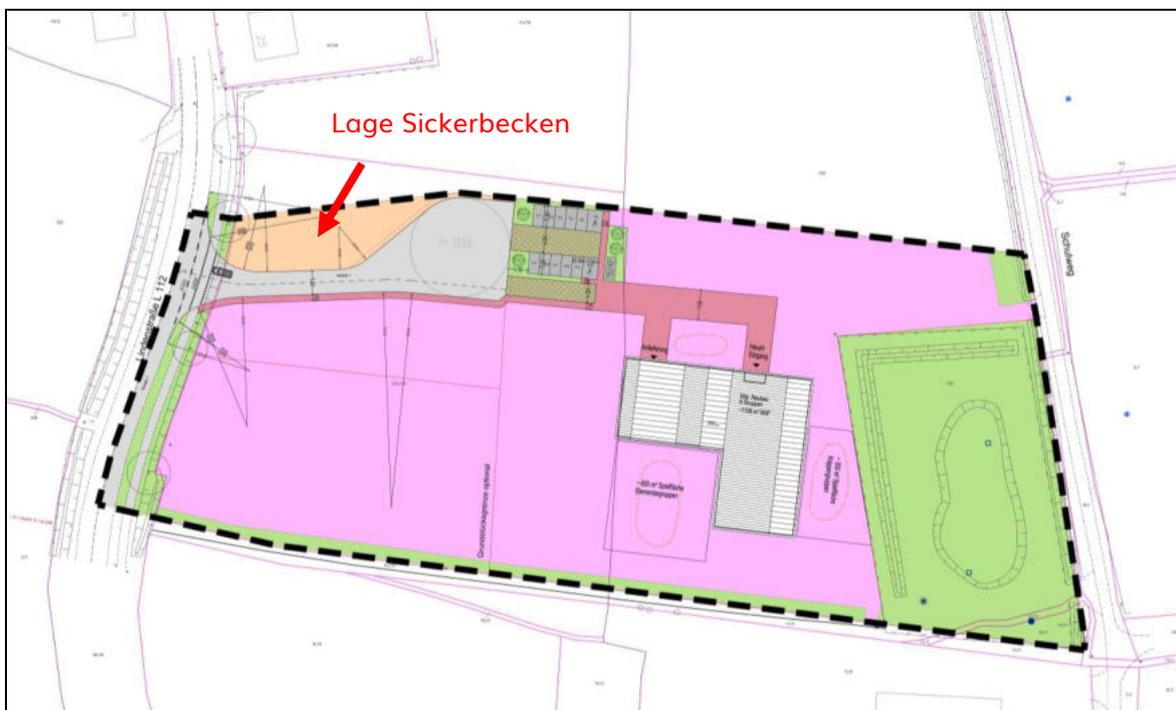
Auszug Lageplan (Nordausrichtung)
